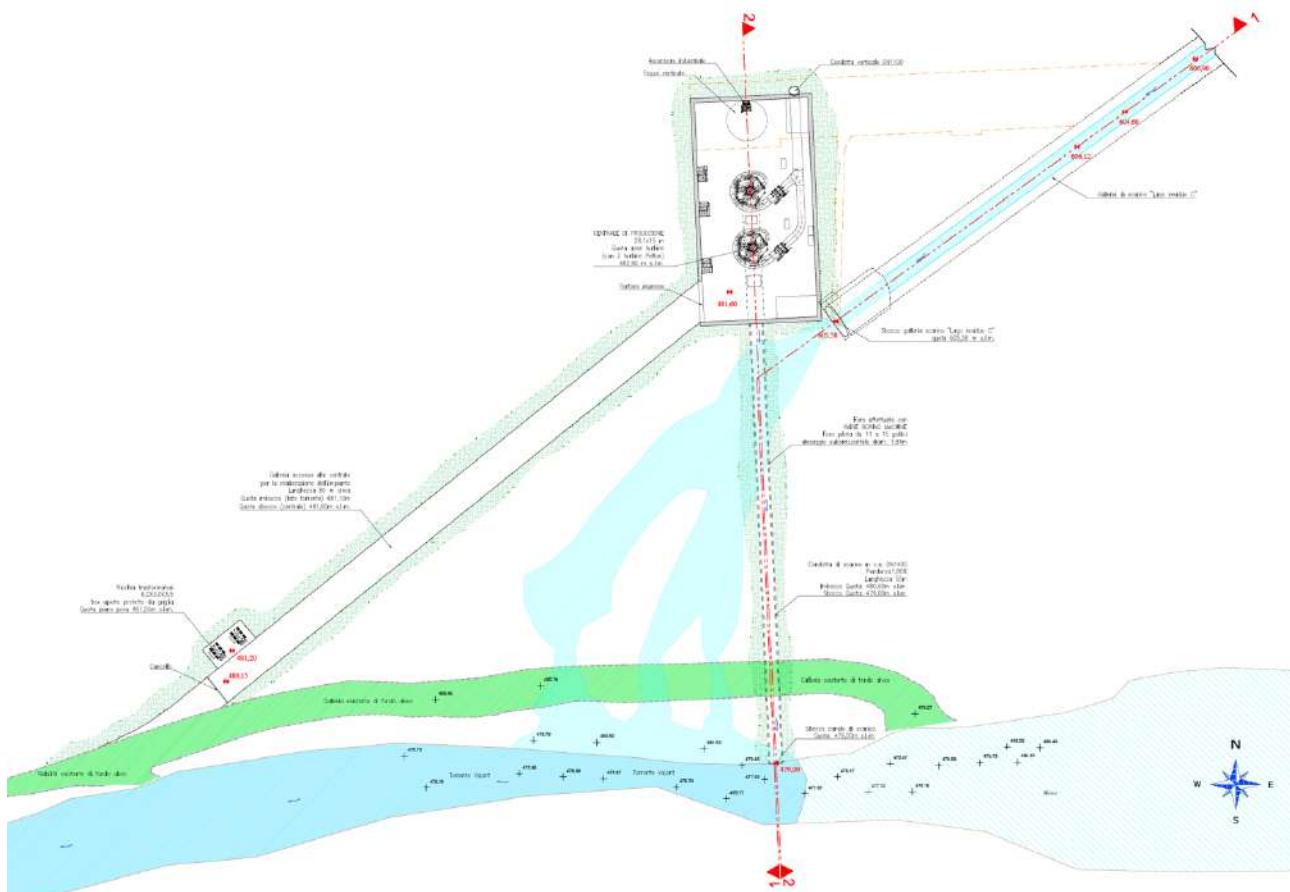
Planimetria di progetto della centrale con galleria di accesso, pozzo verticale e galleria di scarico (in verde la galleria esistente)
